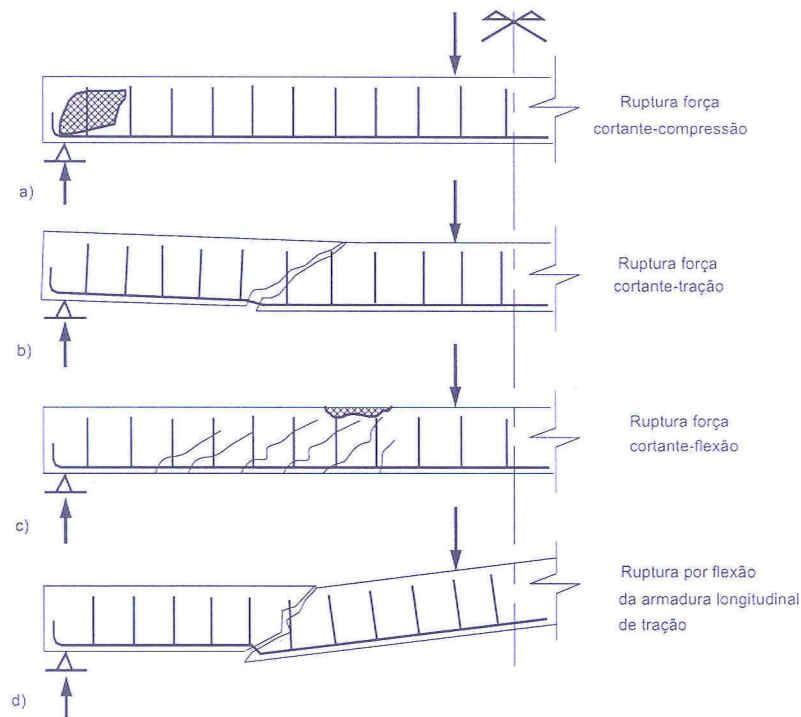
Tipos de Ruptura. (Fig. 3.4, Silva & Giongo/2000)
